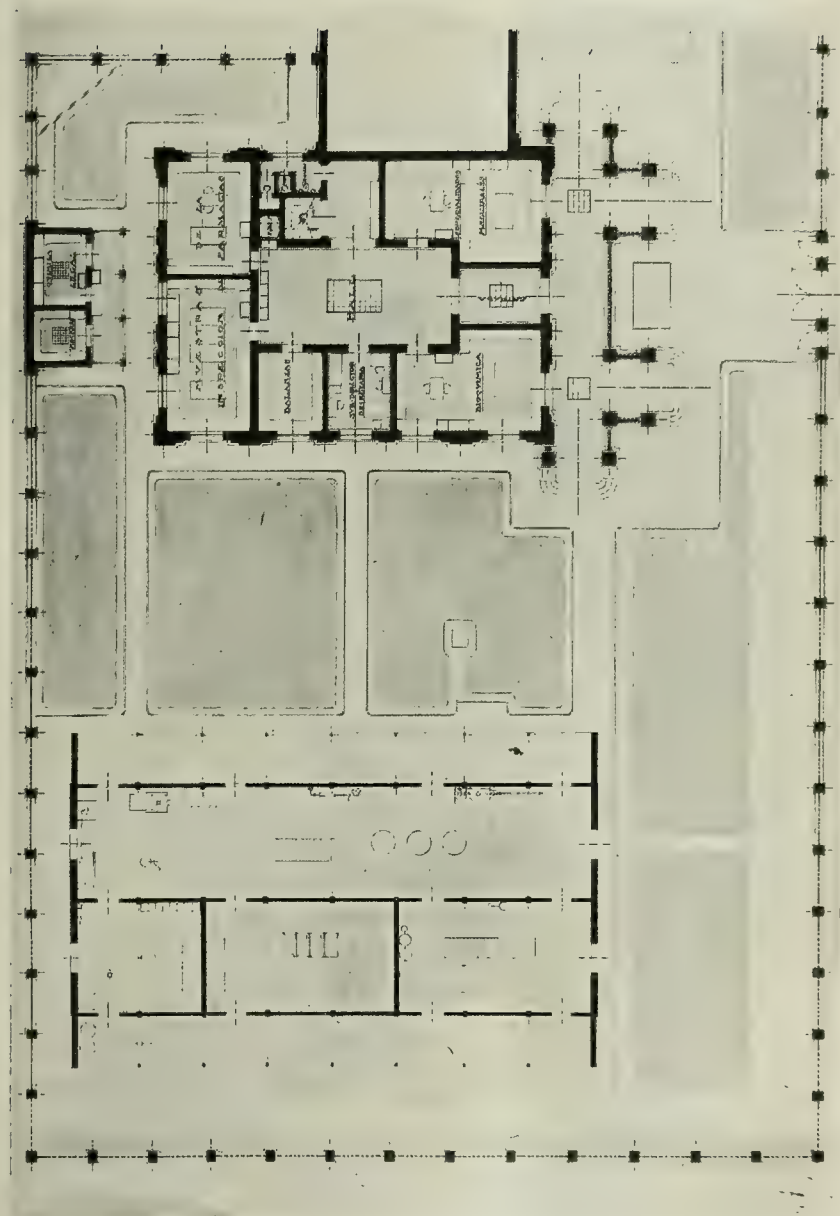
Instituto de química. Planos de la planta baja y de la sección de ensayos industriales anexa
